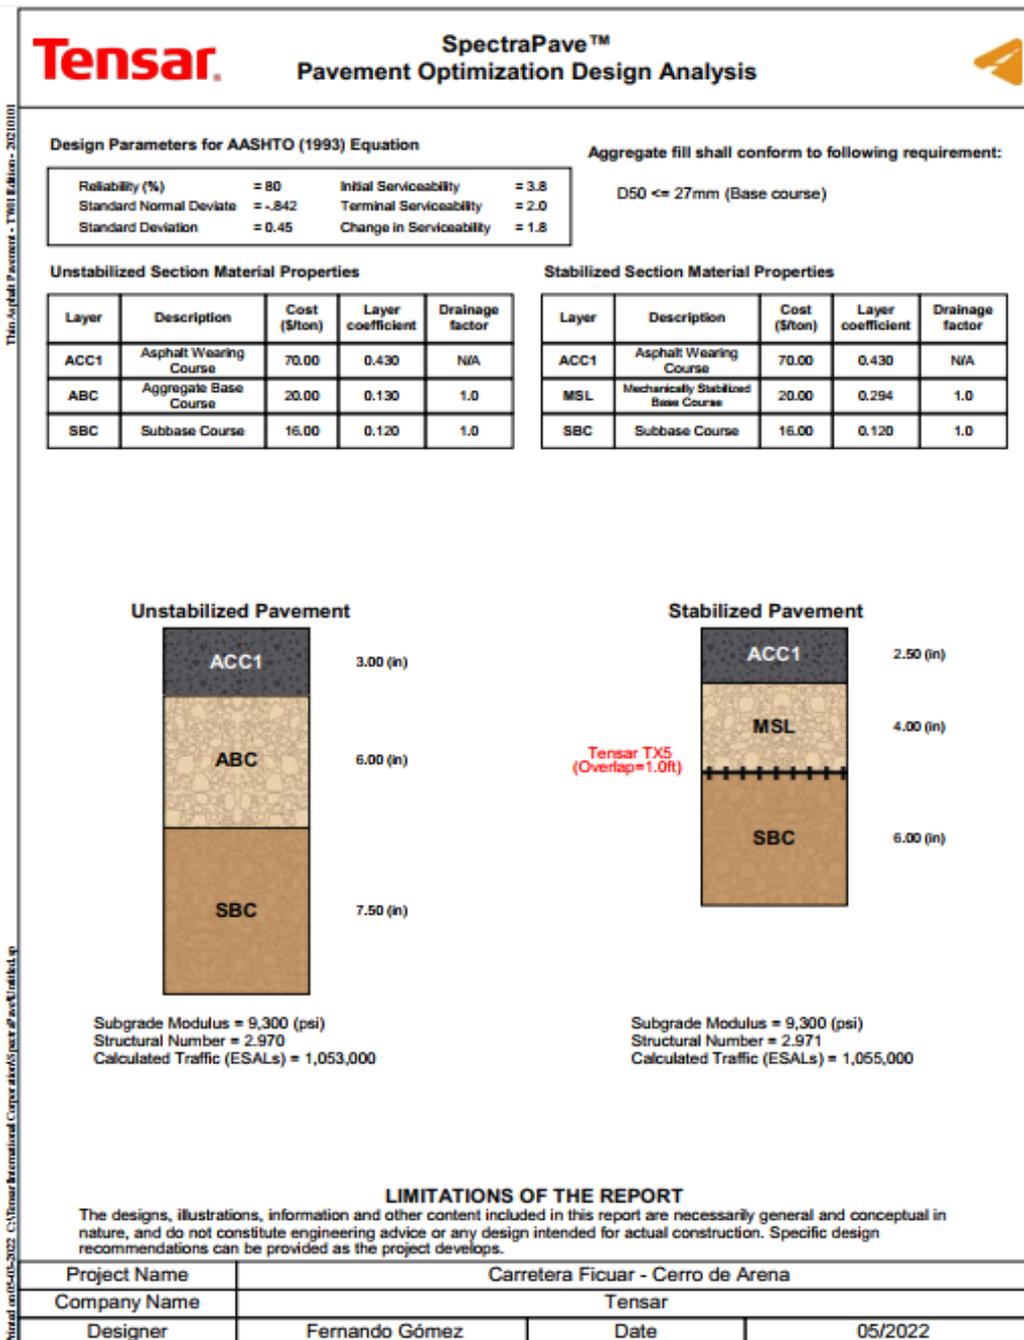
Diseño De Pavimento Flexible Reforzado Con Geomallas
